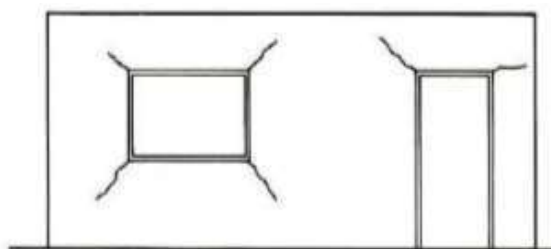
Fissuras inclinadas – ilustração
